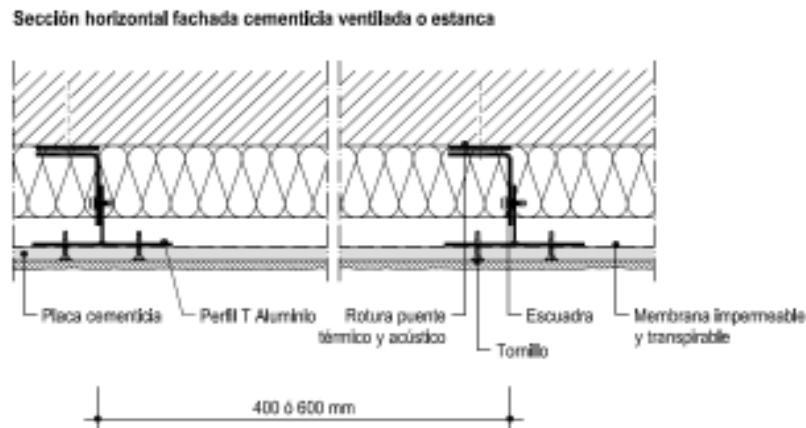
Aislamiento exterior de fachada con, estructura metálica, lana mineral y placa de cemento.
